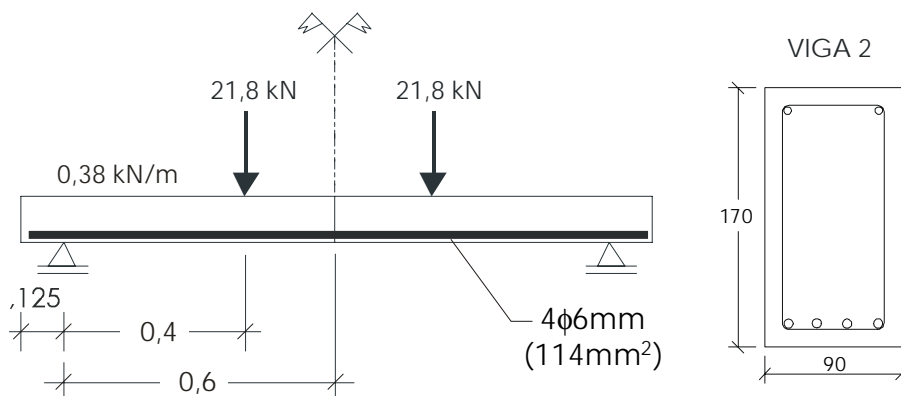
Esquema estático, dimensões e carregamento da VIGA 2
